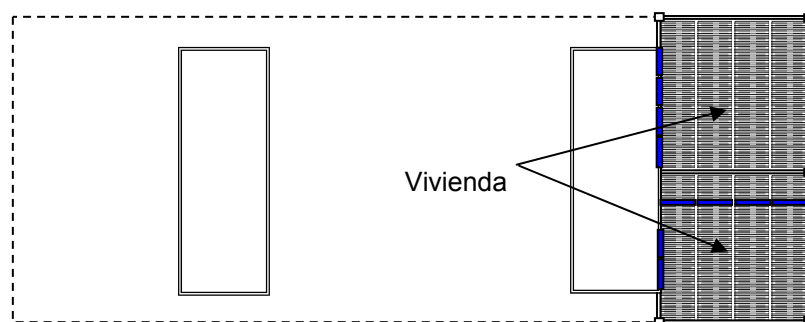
Vista en planta de la zona 3 con los paneles de división estructurales
